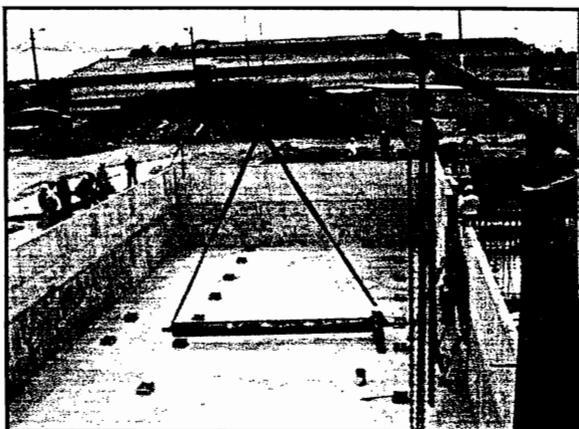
MONTAJE ESTRUCTURA (COLOCACION TAMBOR DE COLA)
